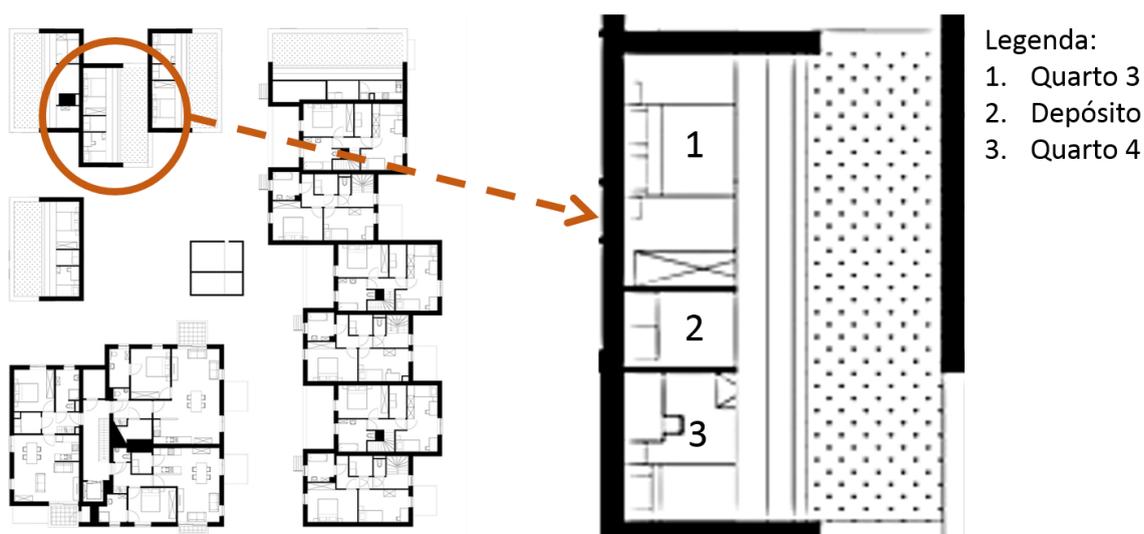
Planta Baixa Primeiro Pavimento Superior, Tipologia Comum B.
